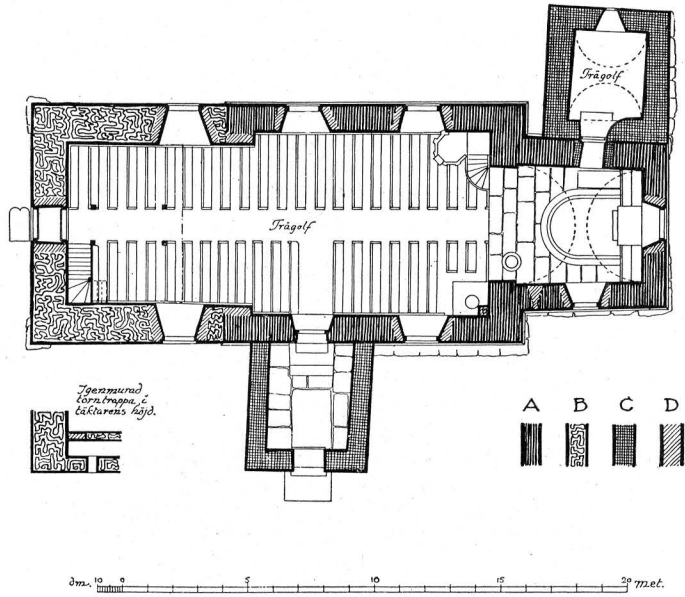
Söne. Plan. Skala 1:300. Uppmätning av A. Roland. Grundriss.
